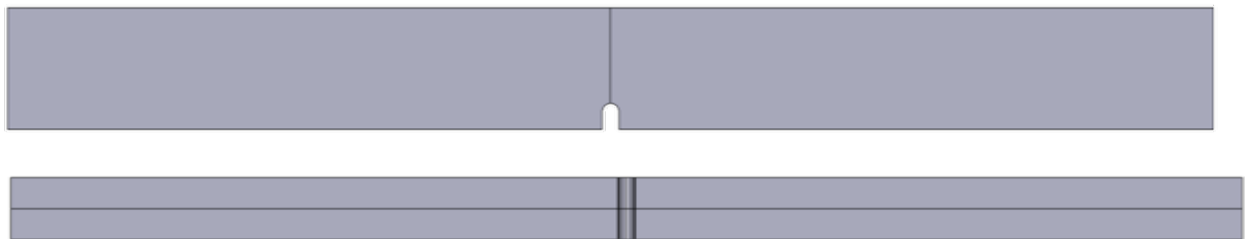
Alzado y vista inferior de la de las probetas tipo PA.
